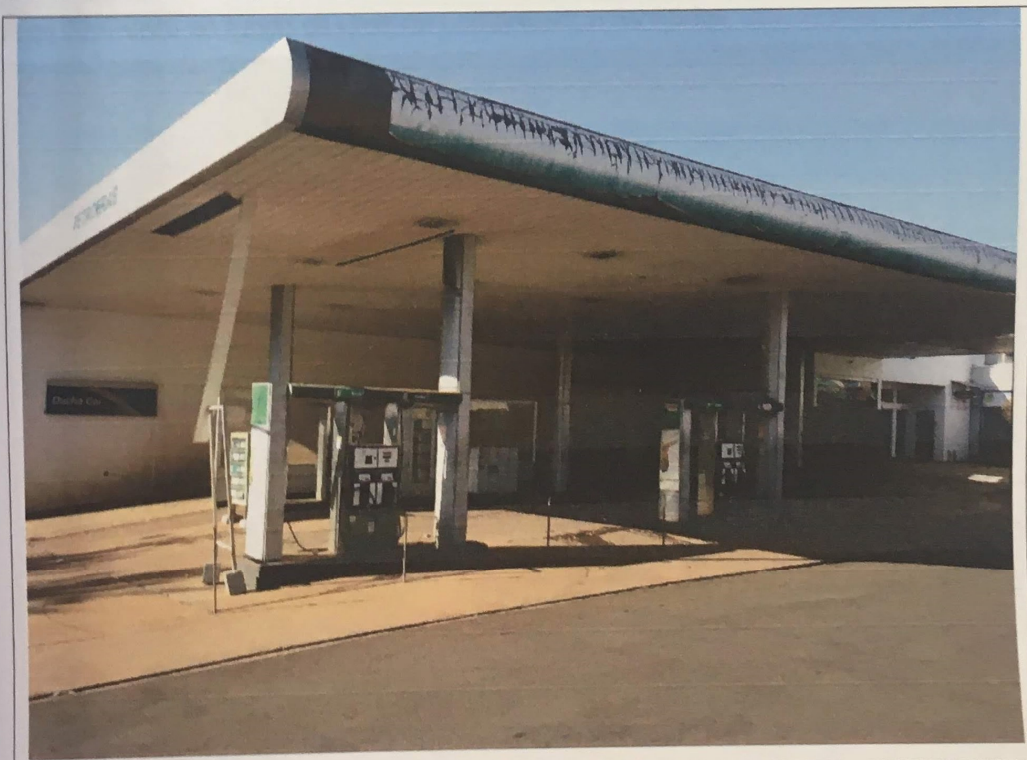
Vista geral do pátio de abastecimento do Posto de Serviços
